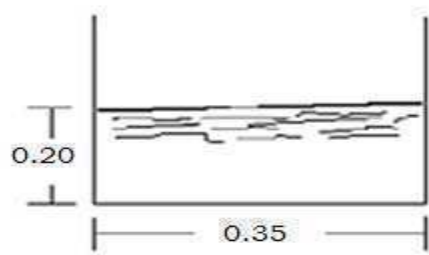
Sección transversal del canal de entrada cotas en metros.
